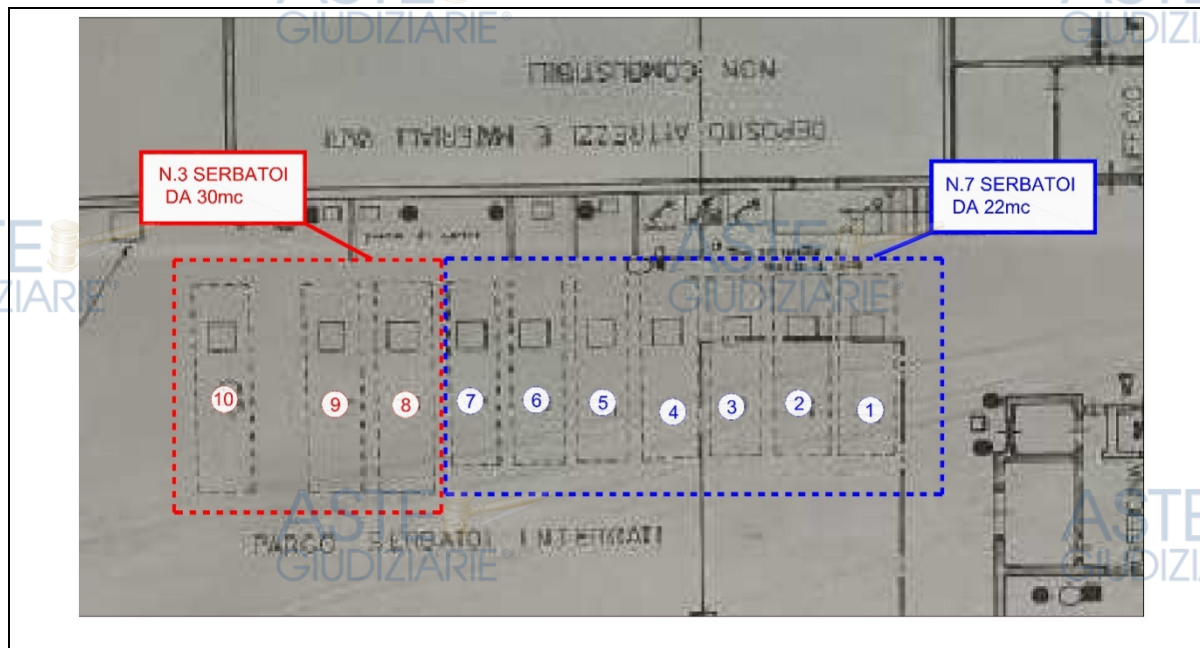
Stralcio planimetrico serbatoi interrati - estratto dalla documentazione tecnica reperita
